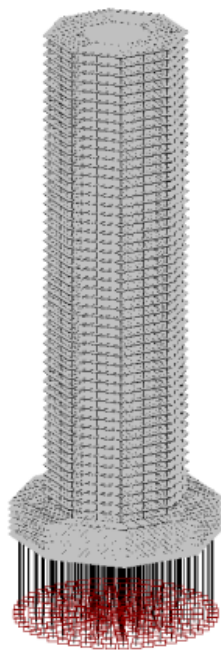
Розрахункова схема будівлі зі паловим фундаментом
